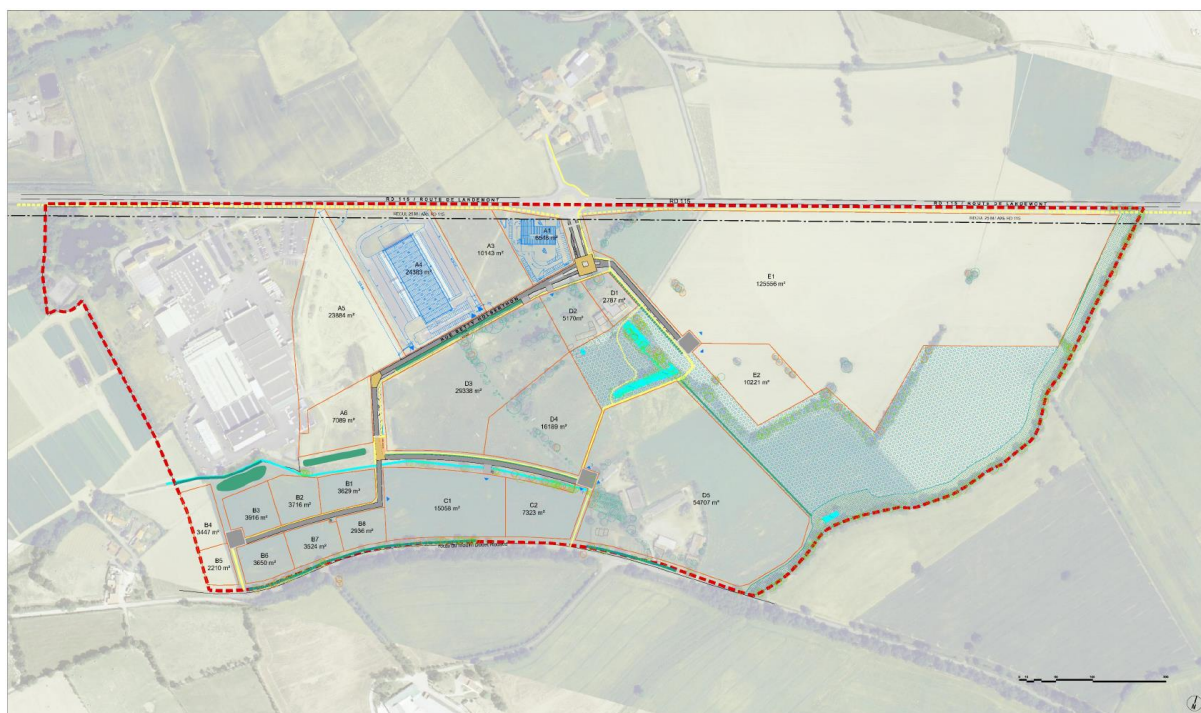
Plan de la ZAC du Plessis (source : Porter à connaissance)
